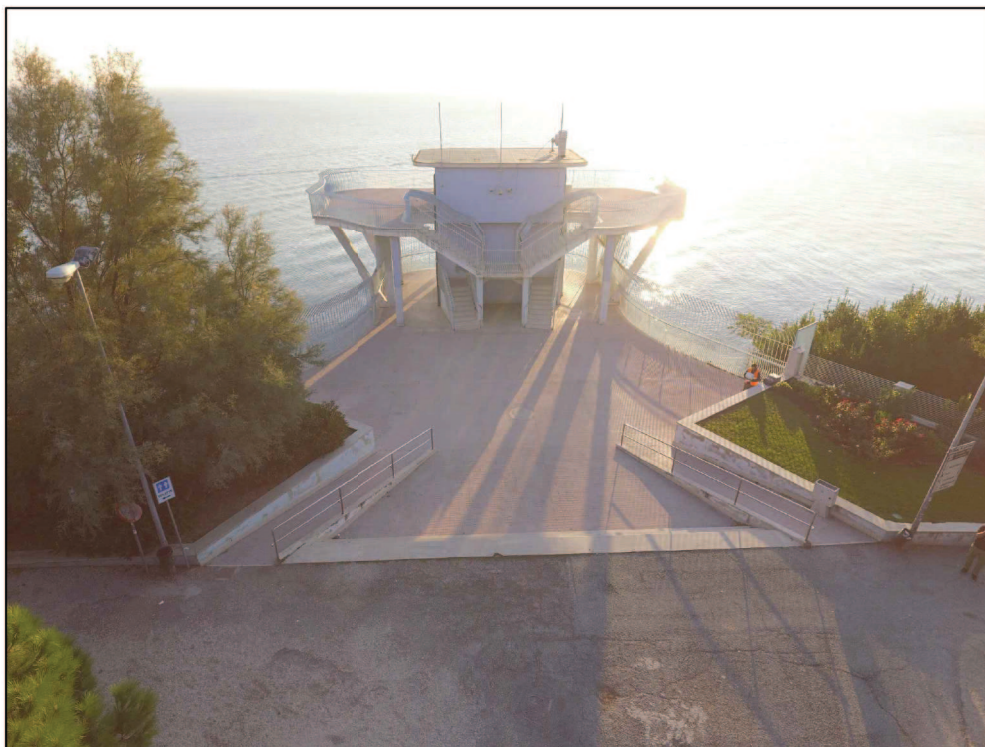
Prospetto Ovest, piano di accesso agli ascensori
